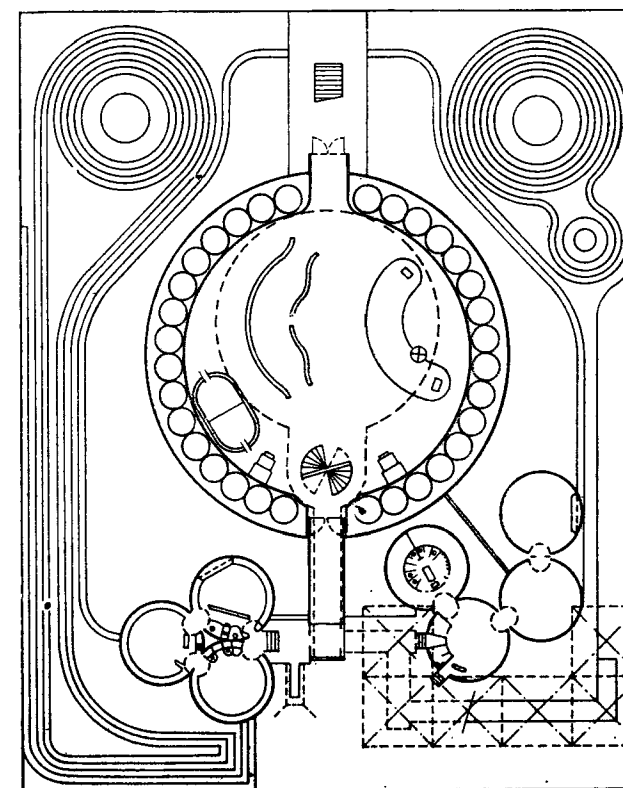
Planul pavilicanelor de expoziție a grupului Fuji, Tokio.
